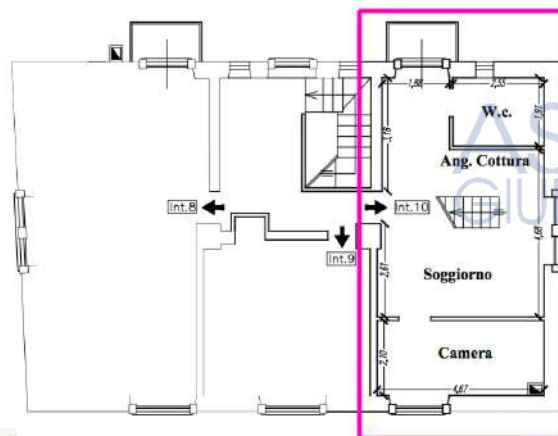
Planimetria del piano 3°, con evidenziato l'appartamento in oggetto
